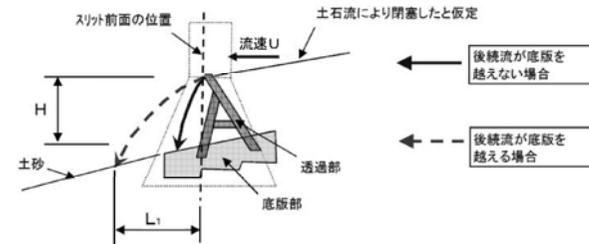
透過型砂防堰堤の後続流の落下位置
